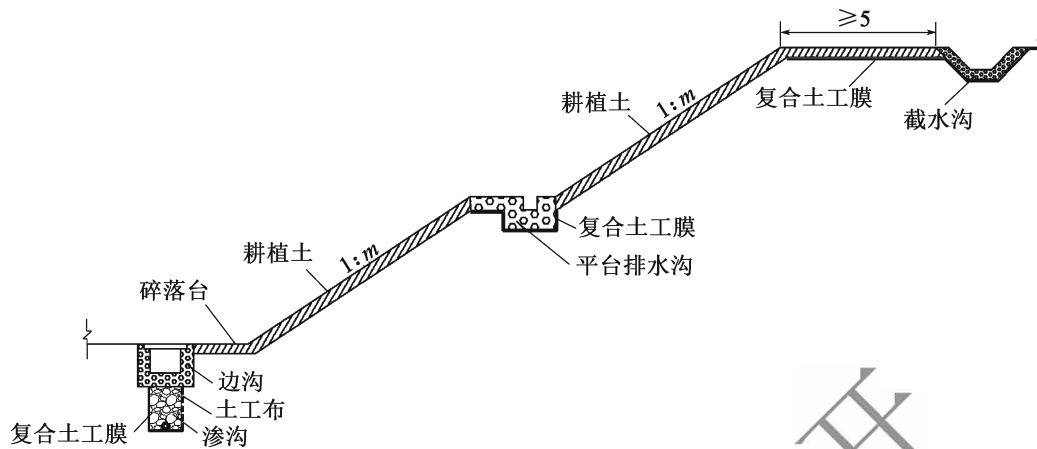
挖方路基地表排水系统示意图 (尺寸单位: m)
